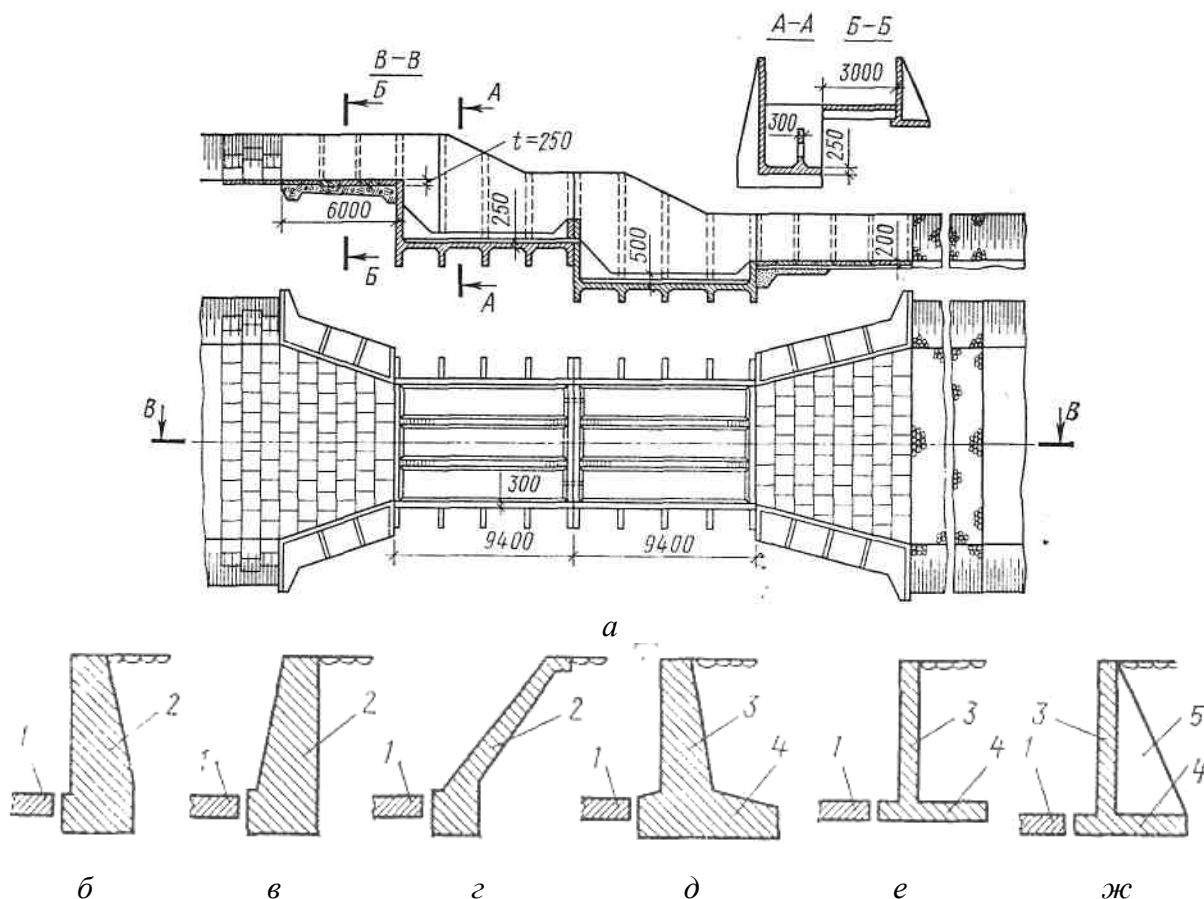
Двухступенчатый железобетонный перепад (а) и типы боковых стенок быстротоков и перепадов (б–ж): б – бетонных с наклонной задней гранью; в – то же, с передней; г – откосных (лежащих); д – угловых массивных; е – угловых облегченных; ж – угловых с ребрами; 1 – дно быстротока или перепада; 2 – боковая стенка; 3 – вертикальная плита; 4 – горизонтальная плита; 5 – ребро
